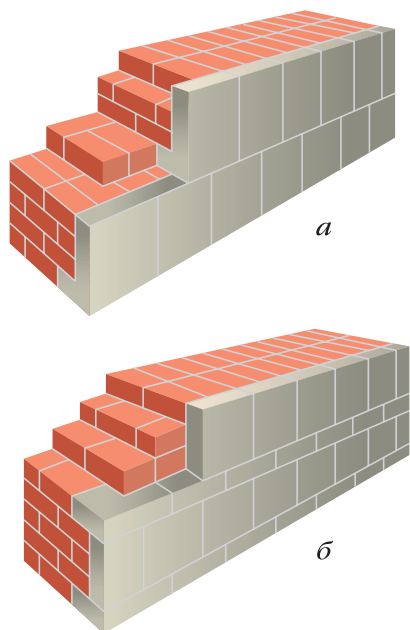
Облицовка фасадов одновременно с кладкой стен: а — с закладной полкой; б — с прокладными рядами
